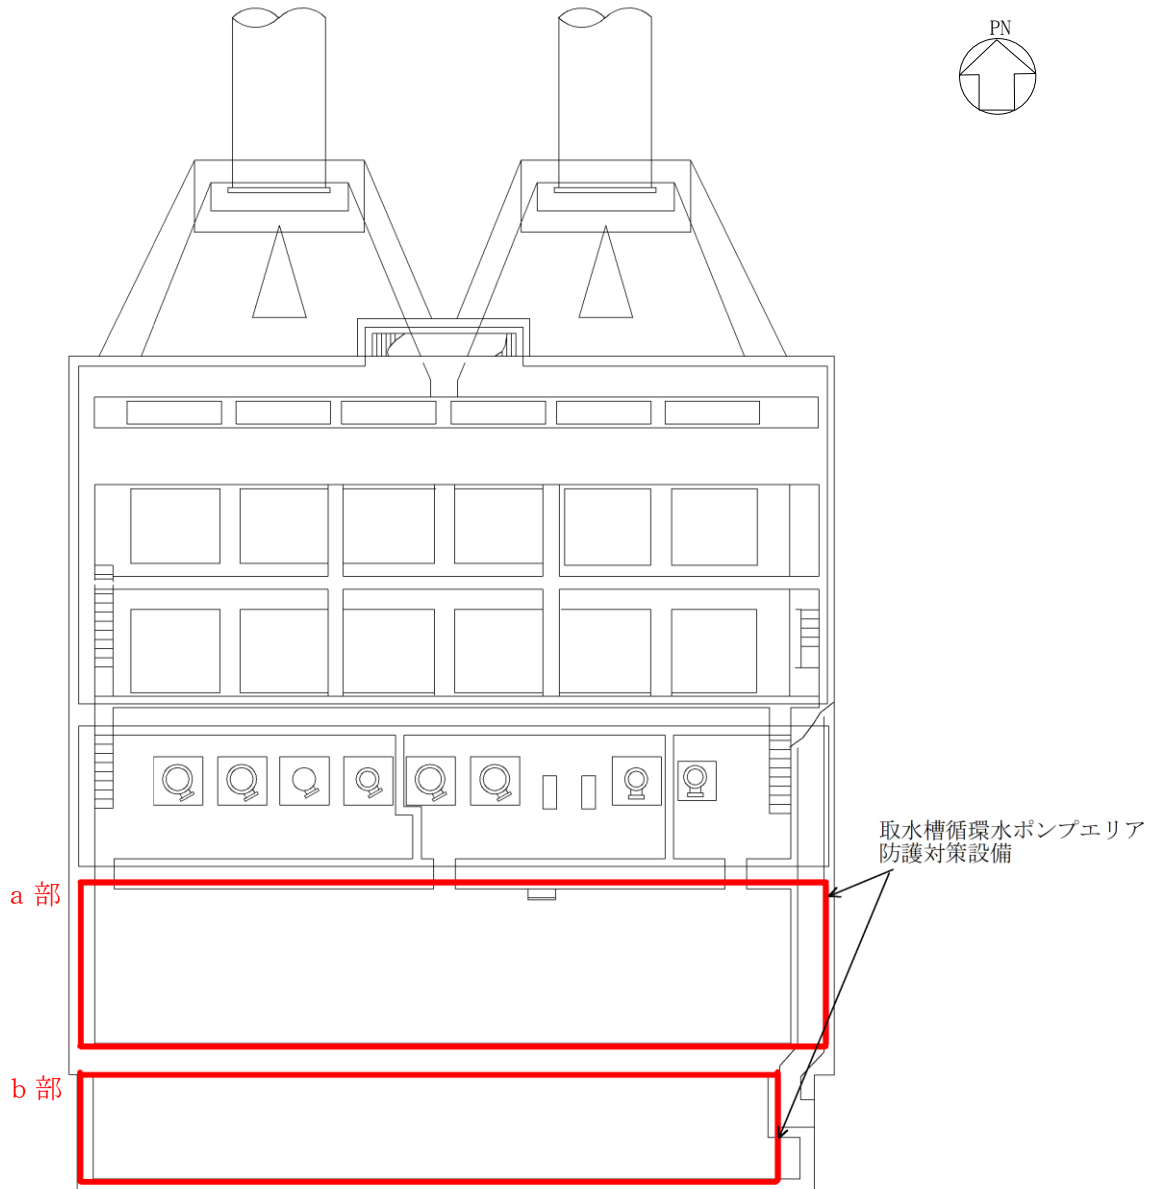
(1) 取水槽循環水ポンプエリア防護対策設備 平面図
